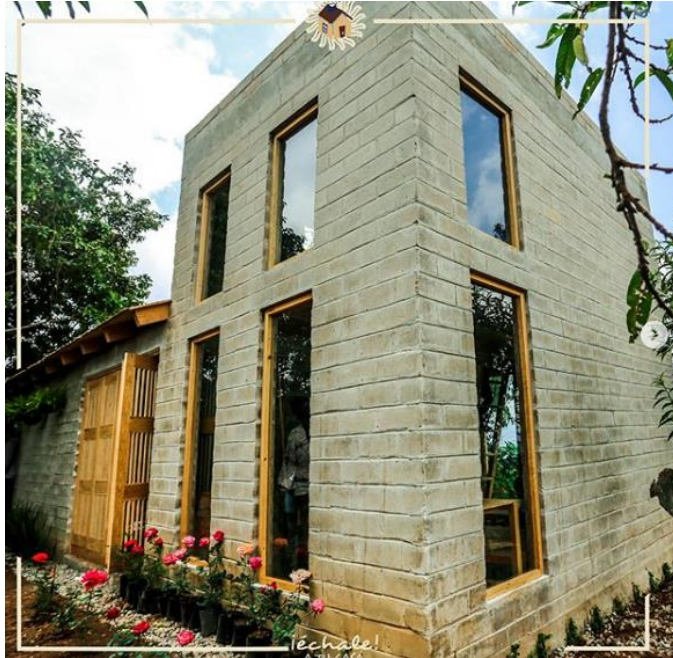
Prototipo de vivienda para Ocuilan, Estado de México Fuente: EchaleMx
